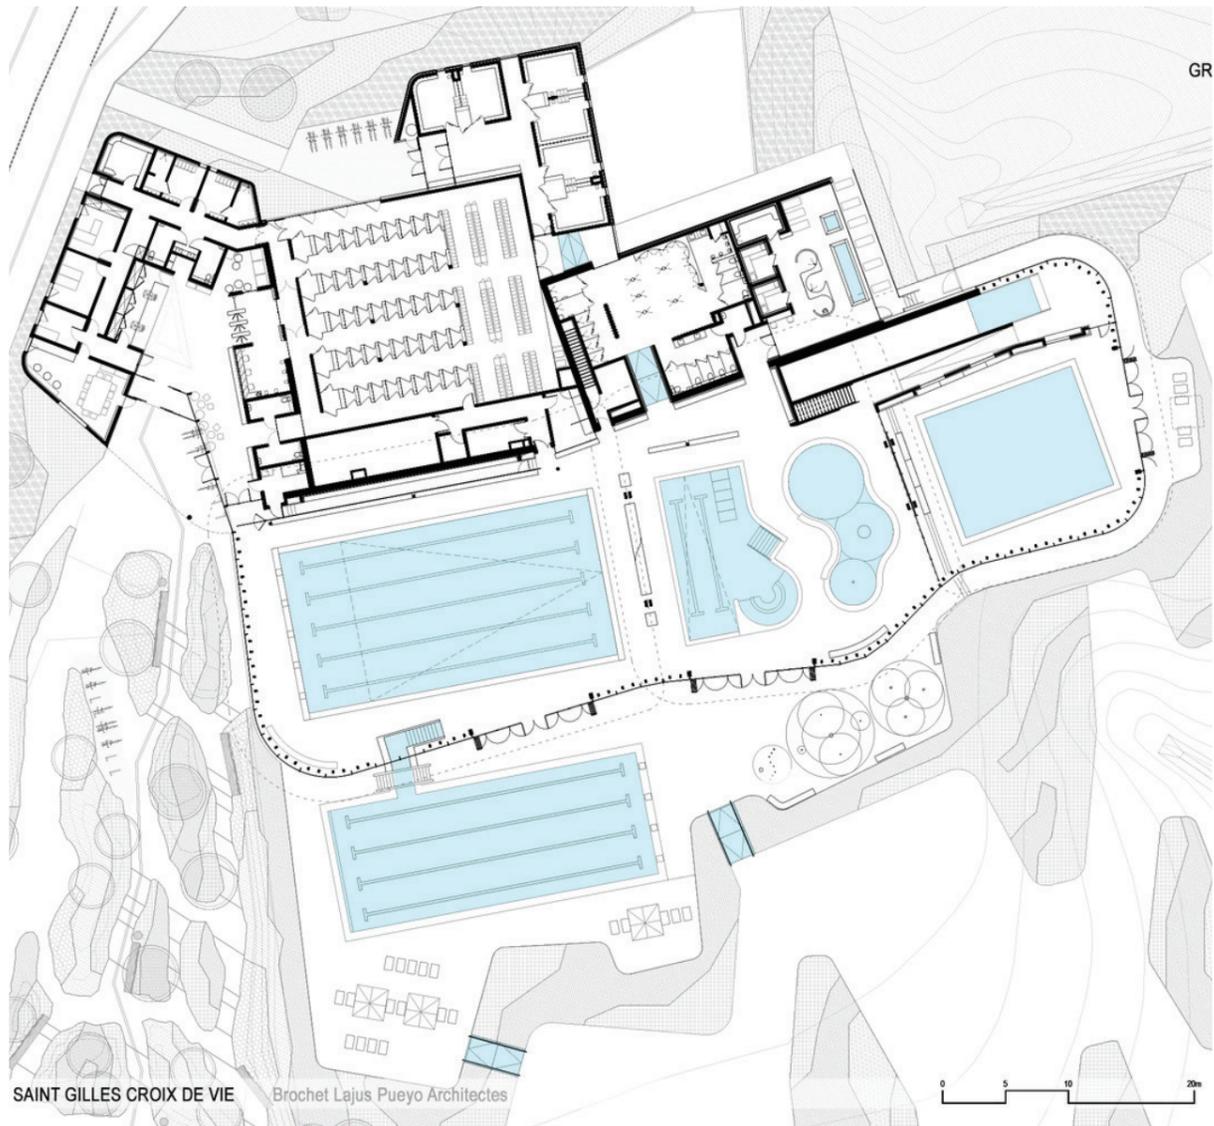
Planta nivel 1 - Saint Gilles Croix de Vie
